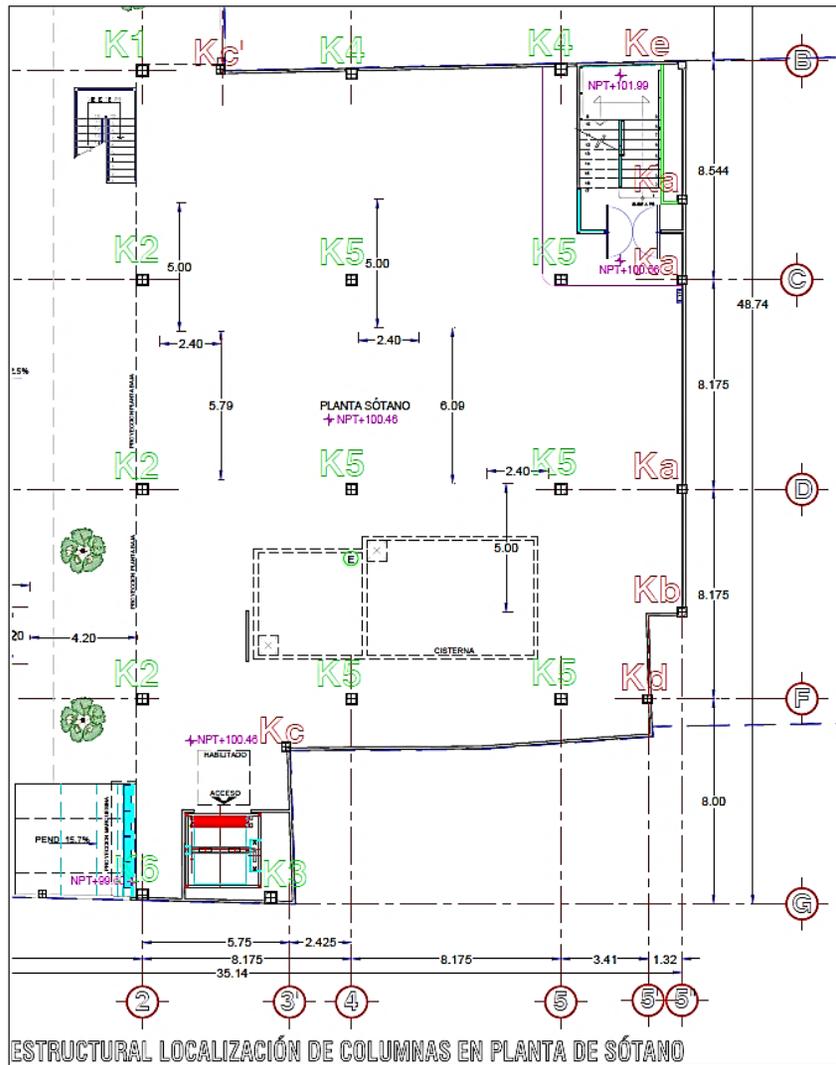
Plano de localización de tipo de columnas en sótano.
